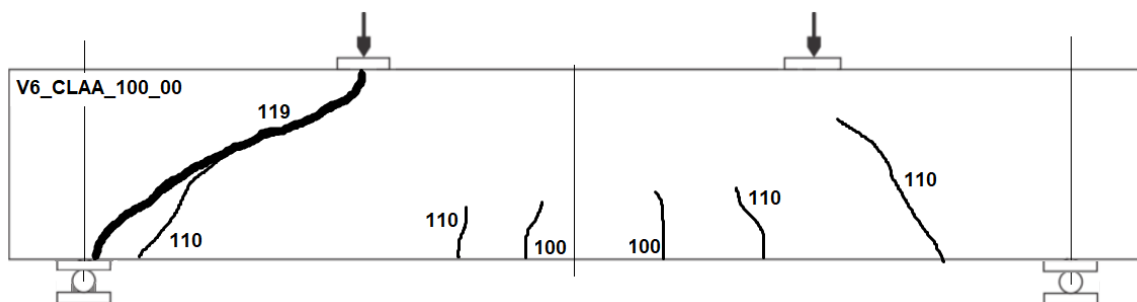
Esquema de fissuração da Viga 6_CLAA_100_00.
